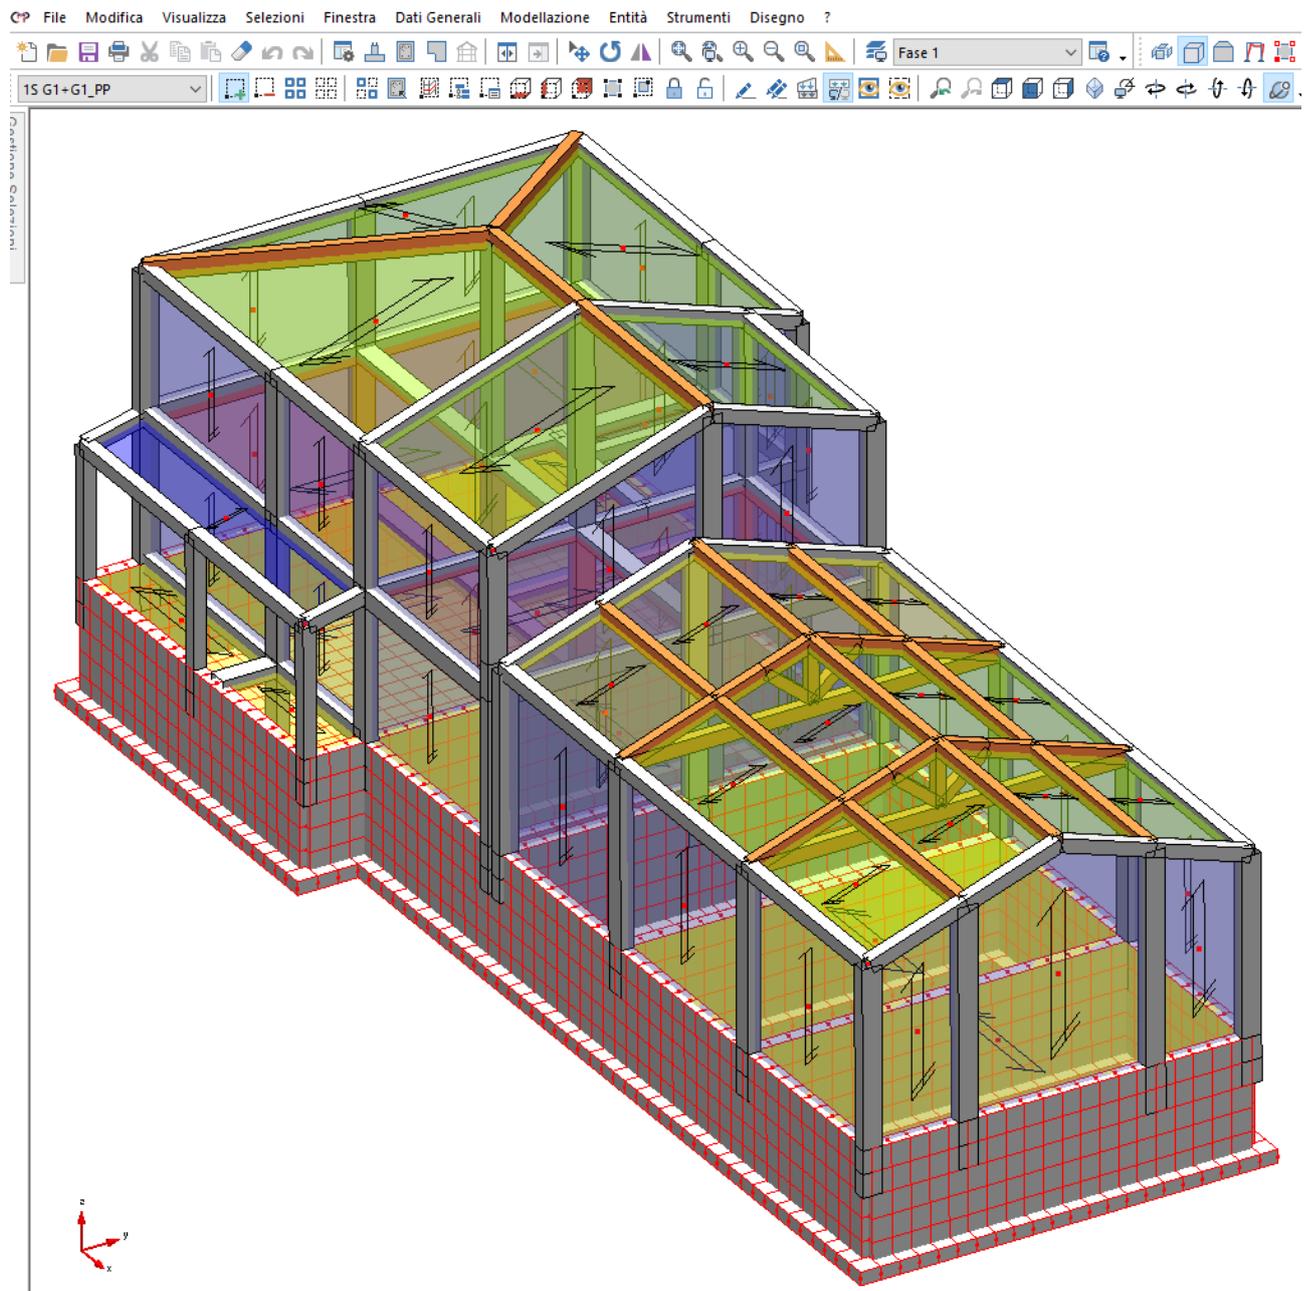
Modello di calcolo 1 – Vista assometrica 3D SOLIDO.
